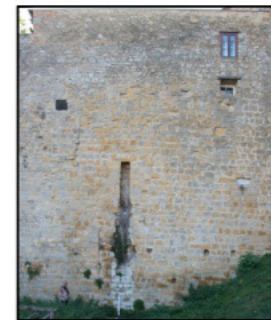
Vista della sezione 15. Presenza di edificio che ha inglobato parte della sezione e dren
